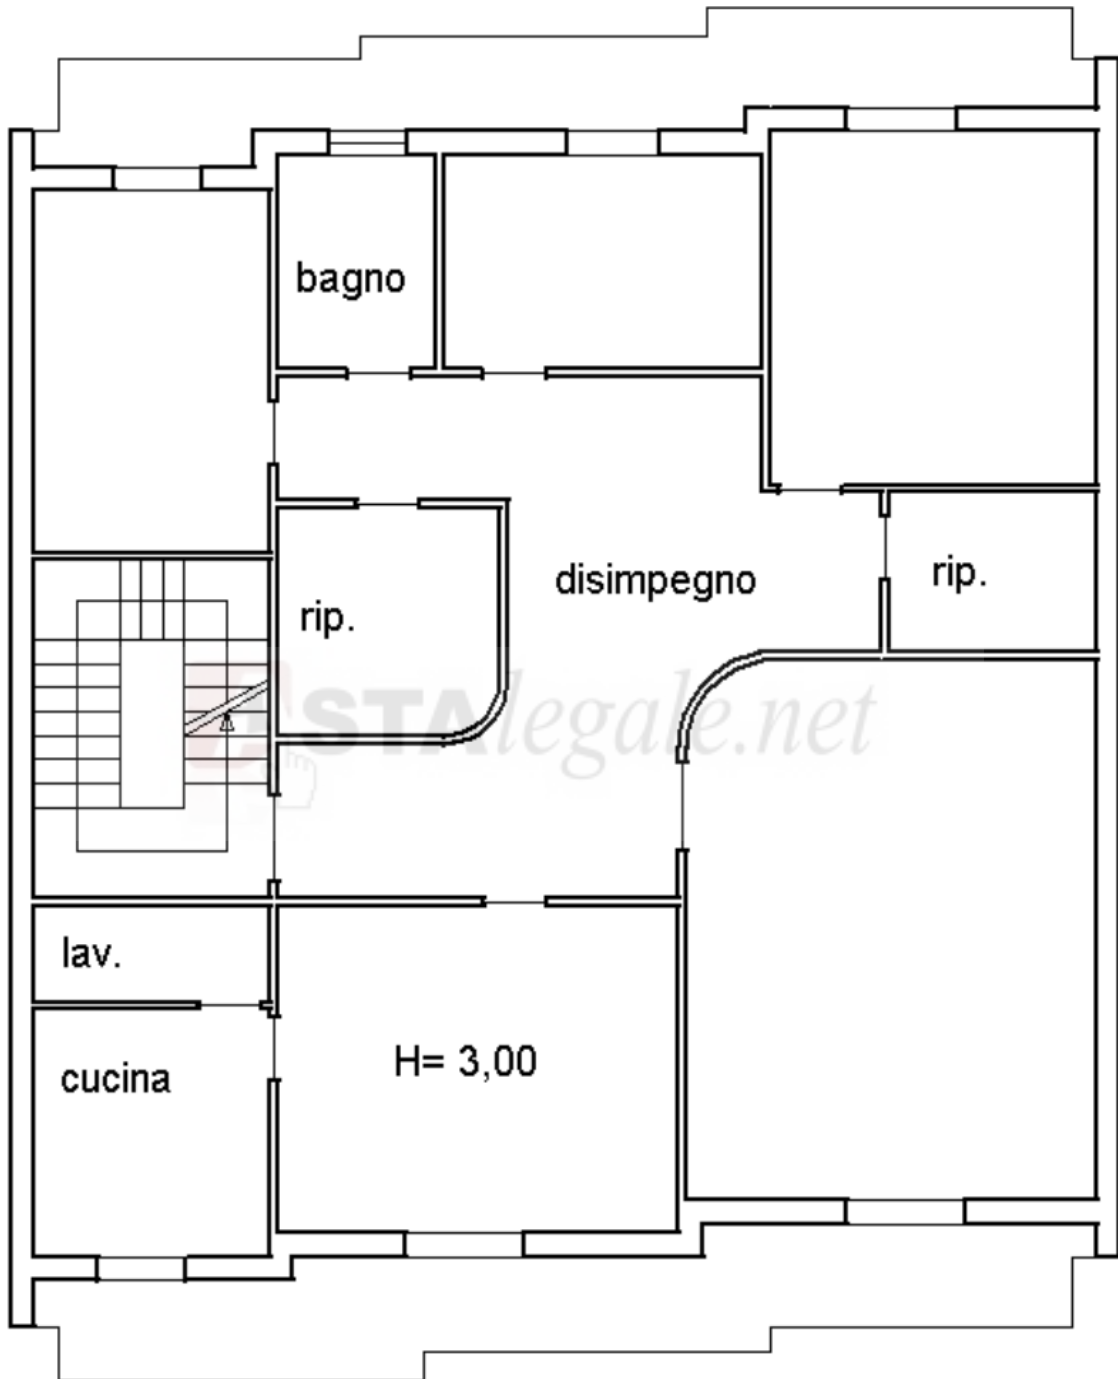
Planimetria Catastale PIANO PRIMO - Foglio n°76, Particella n°1598, Sub 4
